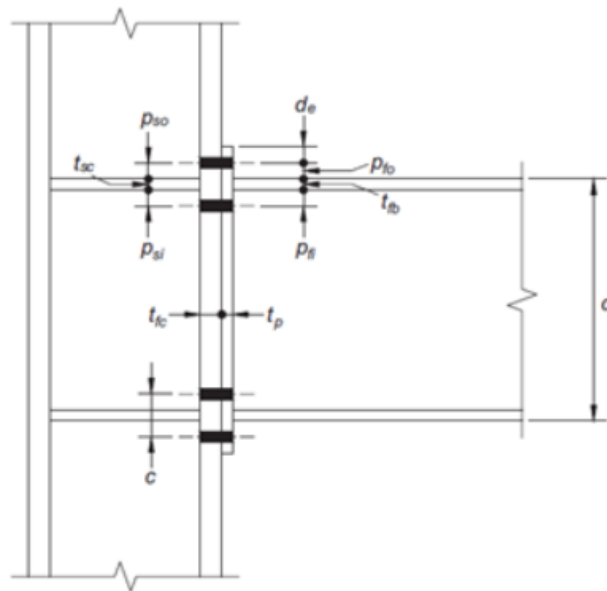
Conexión tipo placa final sin rigidizar (4E) Vista en planta
